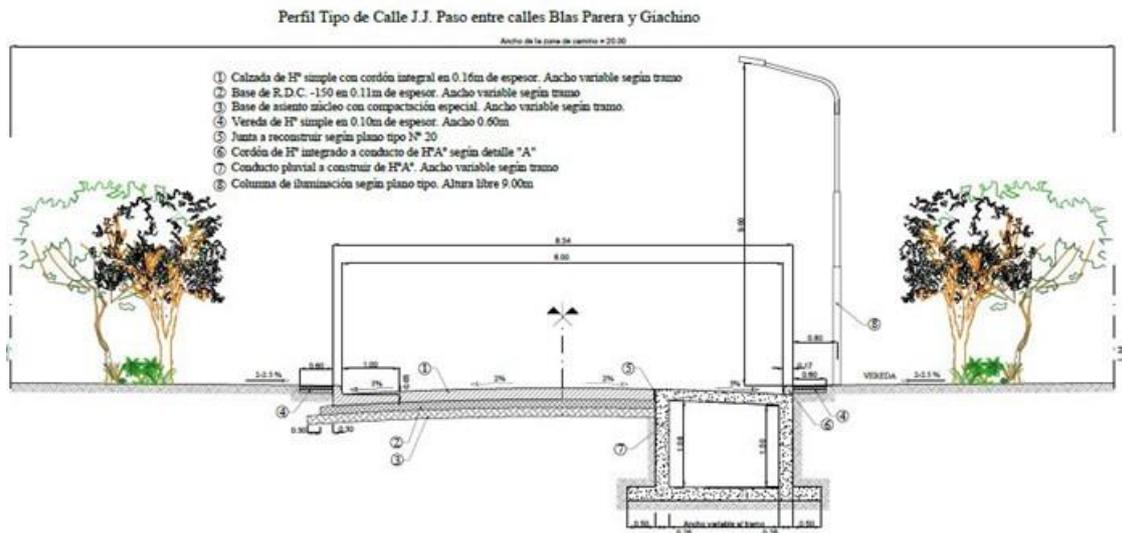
Perfil de Obra tipo Calle JJ Paso -Fuente: Informe de Ingeniería.
